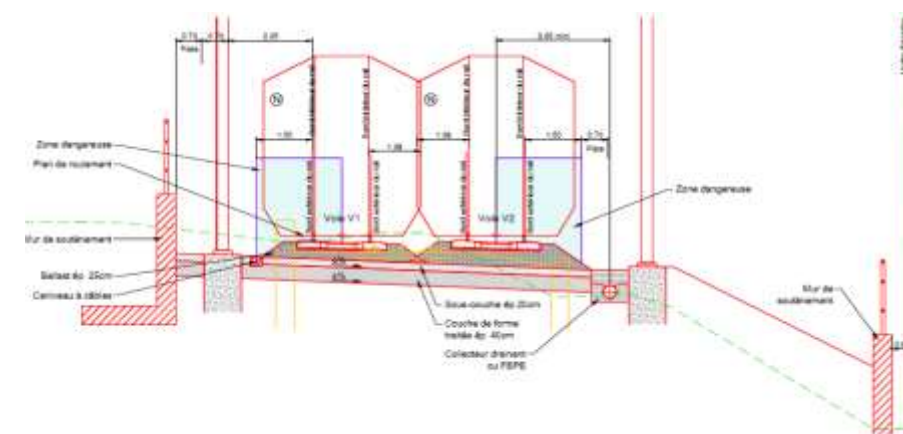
coupe type en zone de remblai avec mur de soutènement en pied de remblai
